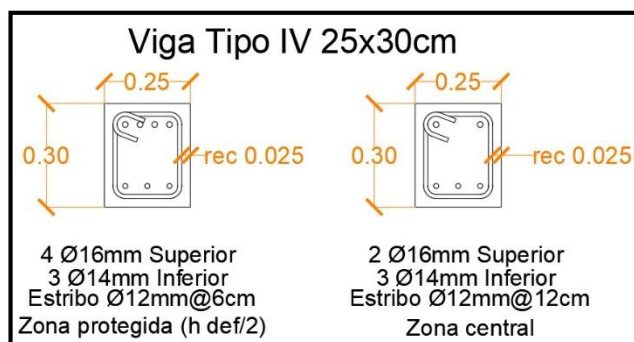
Sección de la Viga Tipo IV. Fuente: Nicolás Pozo
